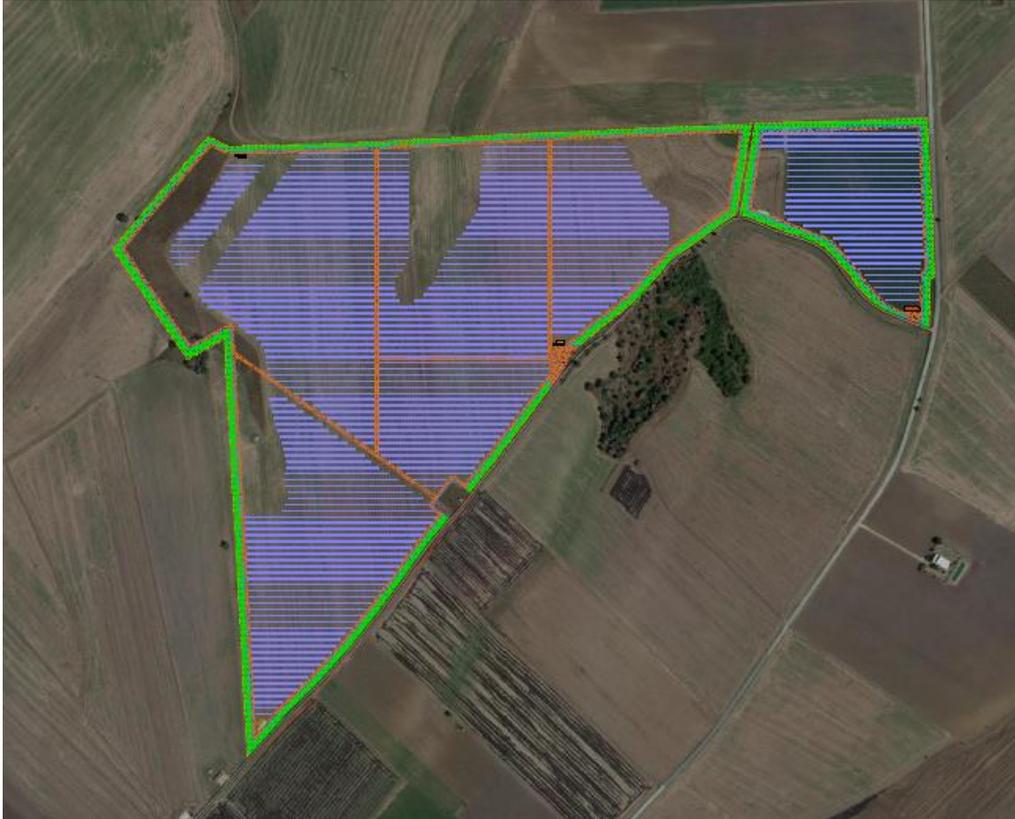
Layout dell'impianto agrivoltaico del "Lotto Venosa Boreano" su ortofoto.
